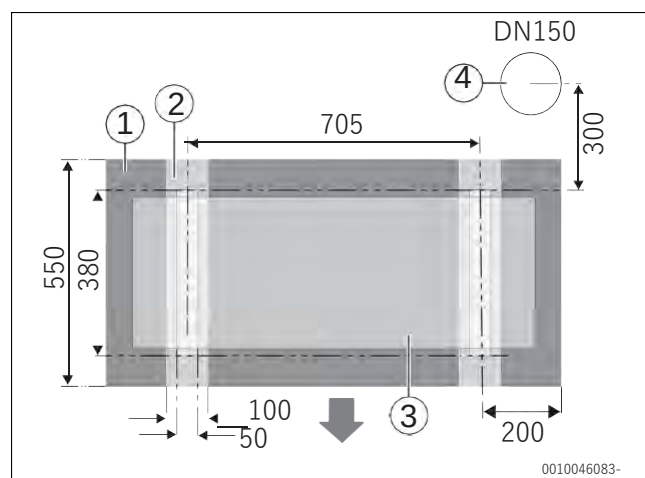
Vnitřní a vnější instalace (rozměry v mm)
